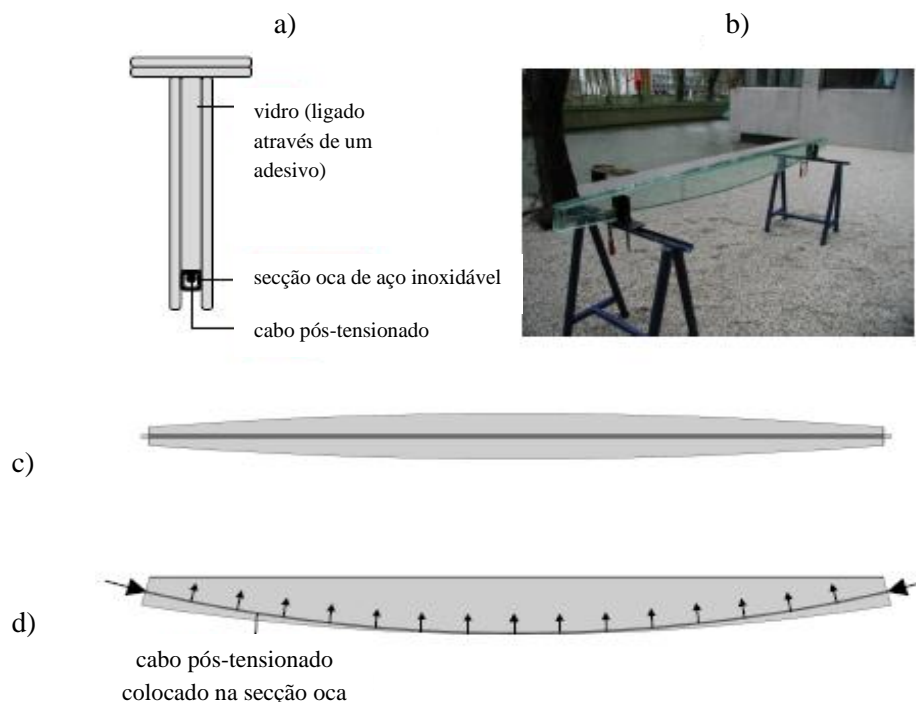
(a) Secção transversal da viga de vidro em T; (b) Imagem do protótipo da viga; (c) Vista em planta; (d) Alçado lateral. (adaptado Louter, 2011).
